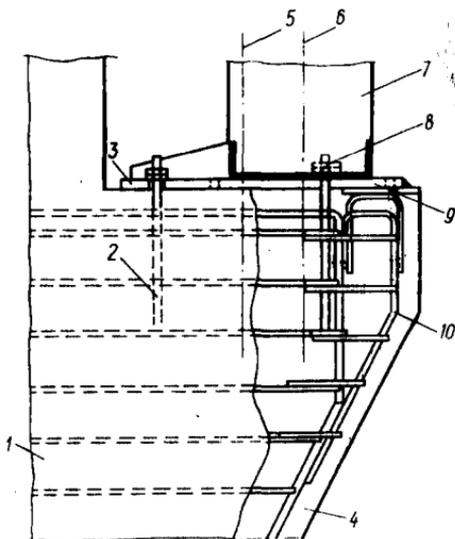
Наращивание колонны при перемещении подкрановой балки в плане
